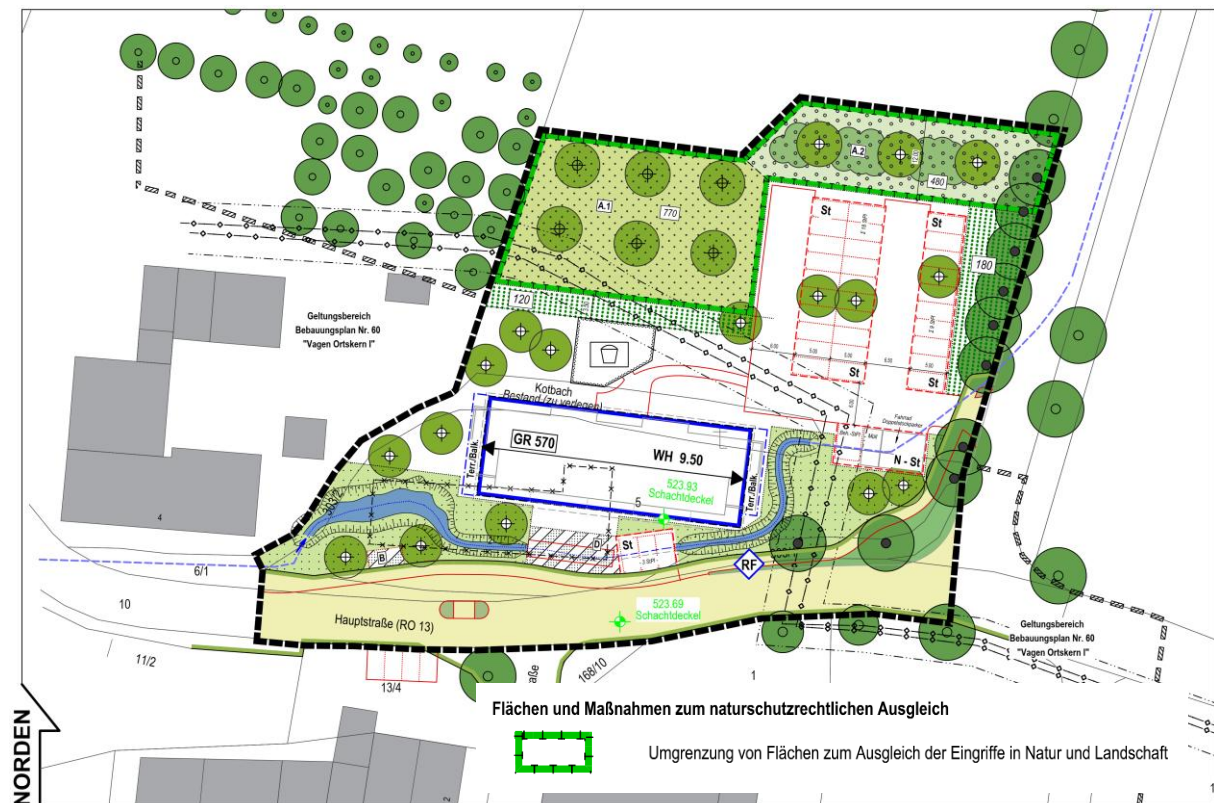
Auszug Planteil des Bebauungsplans mit Lage der Ausgleichsflächen – ohne Maßstab
